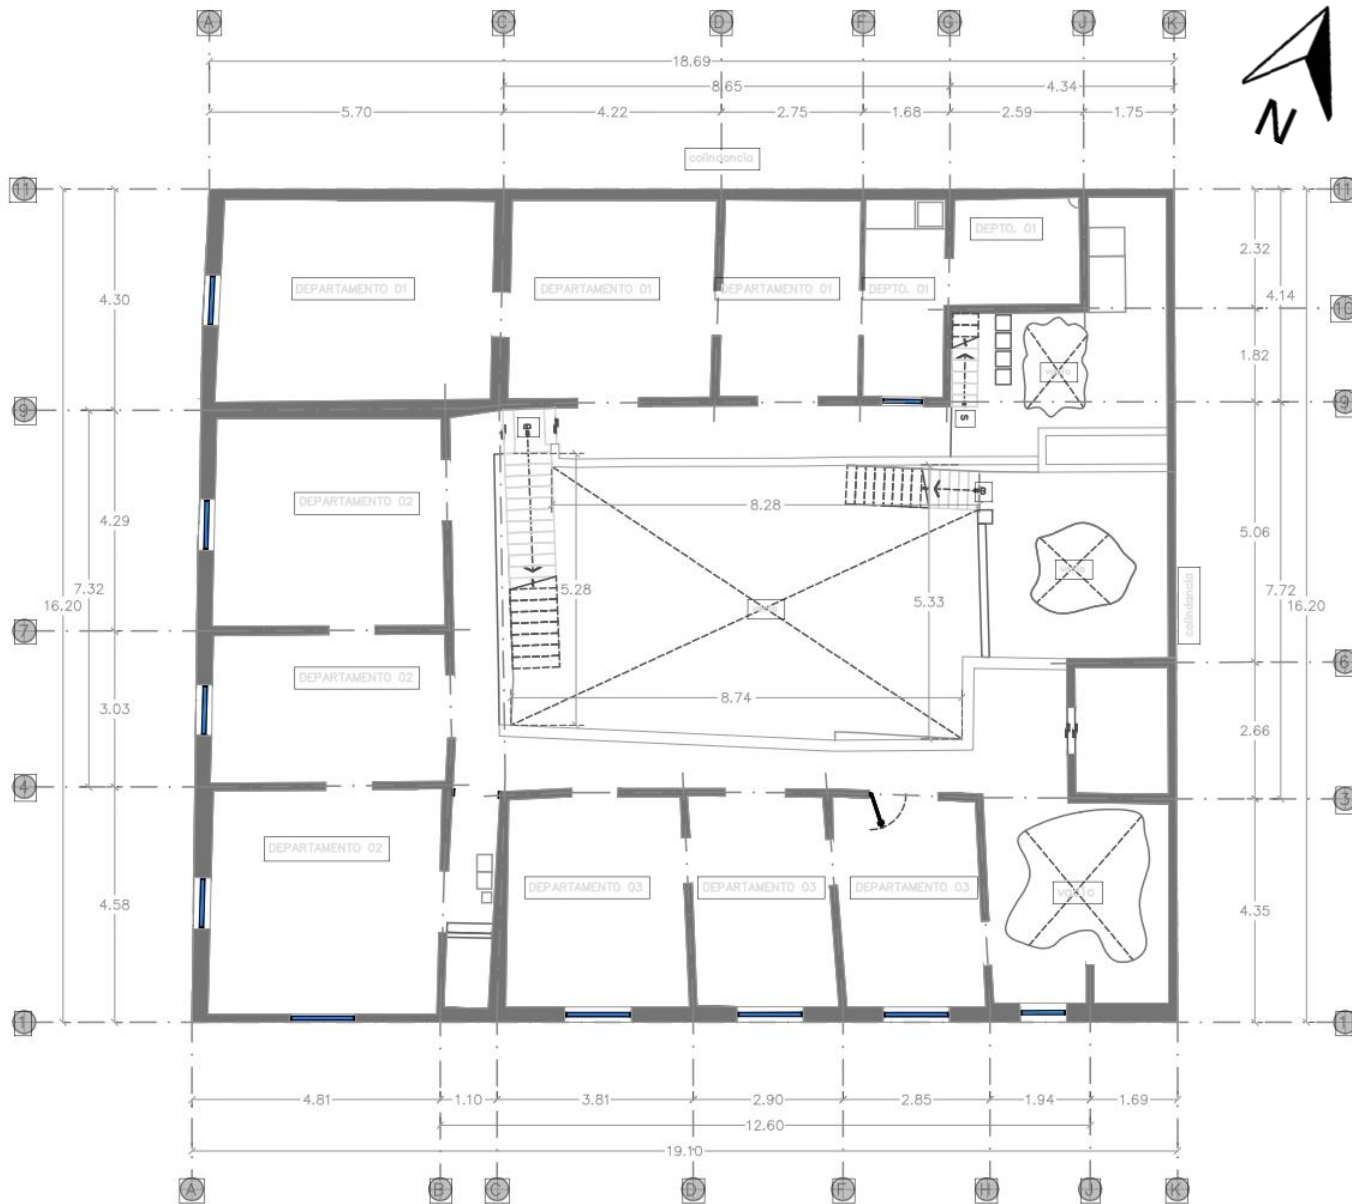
Plano de levantamiento de Planta Baja "Casa Anarco" Fuente: Elaborado por el equipo de Re Genera Espacio
